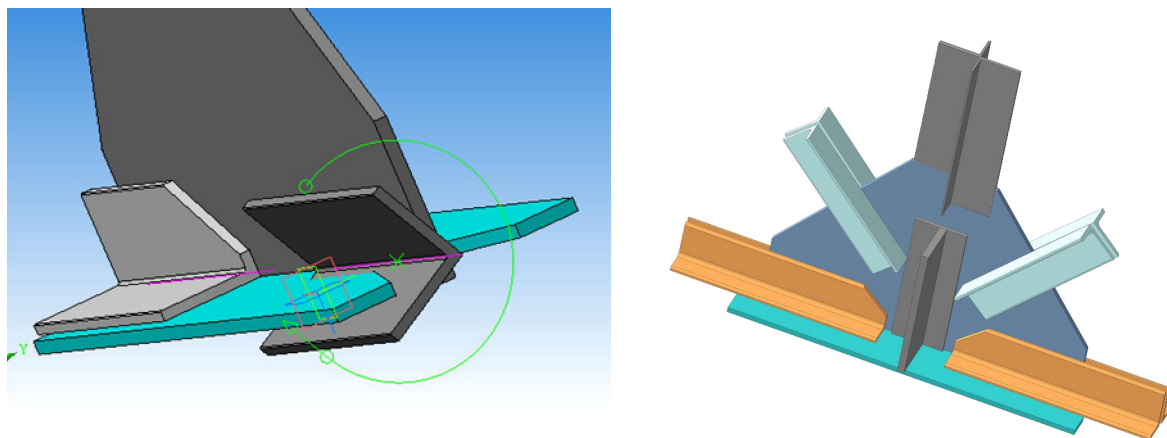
Этапы выполнение 3D-сборки узла металлоконструкции
